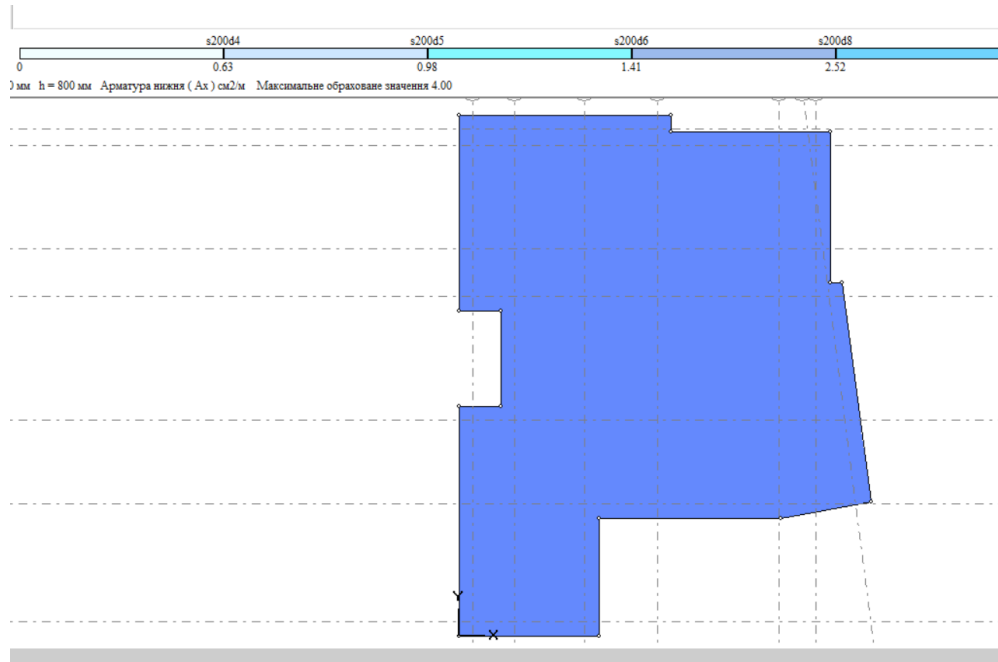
Арамування фундаментної плити по осі Х
